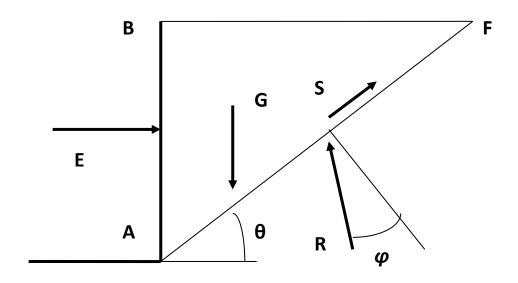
Схема к постановке задачи о давлении грунта на подпорную стену
